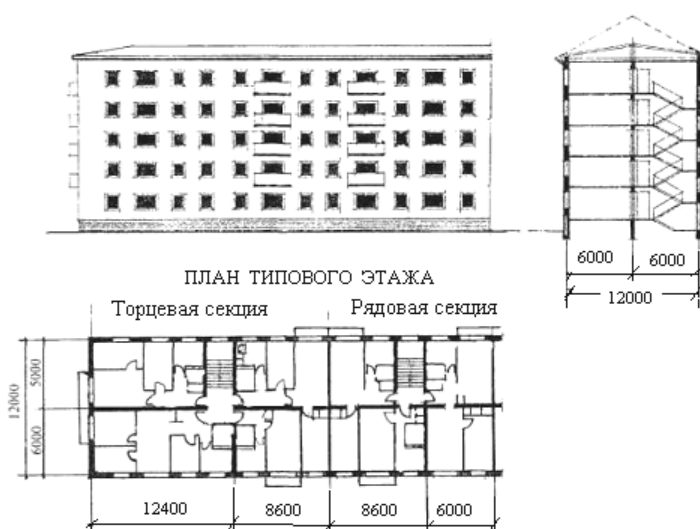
Фасад, план типового этажа и разрез жилых домов с кирпичными стенами серии I-447
